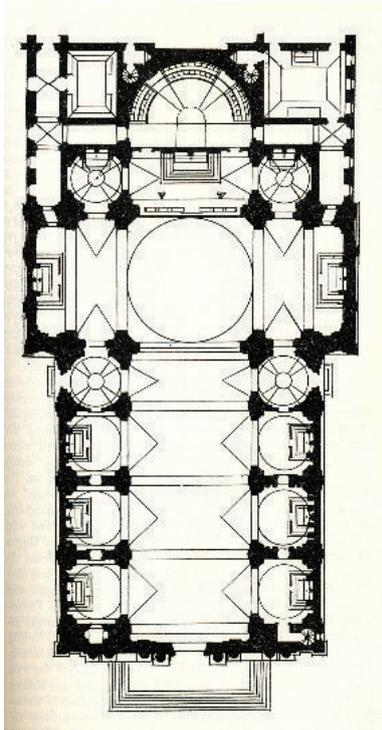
S. Andrea della Valle, Grundriss, Rom.
